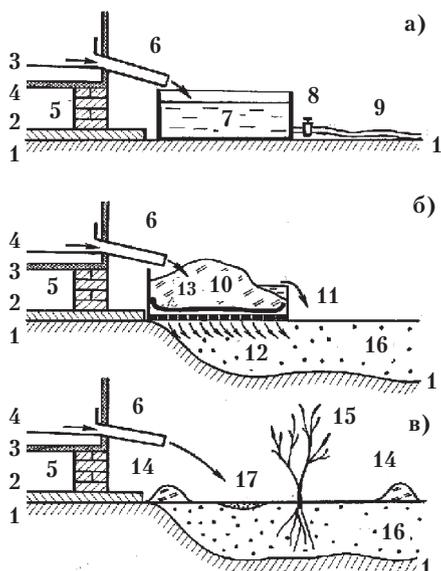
Схемы сбора и обработки стоков бани, сауны, душа на садовом и дачном участке: а – ассенизационная схема, б – схема компостирования, в – схема прямого сброса в фильтровальную траншею. 1 – грунт (почва), 2 – бетонная плита фундамента, 3 – ограждающие конструкции бани (полы, стены), 4 – поддон банный, 5 – цокольные столбики, 6 – сливной выпуск из поддона, 7 – бак-накопитель, 8 – кран шаровой, 9 – шланг поливочный, 10 – компостная куча (торф, старый перегной, песок, доломитовая мука), 11 – перелив очищенной (осветленной) сточной воды, 12 – фильтрующее дно, 13 – фильтрующая мембрана (войлок, лавсановая или капроновая ткань, нетканый синтетический материал, поролон и т. п.), 14 – обваловка места слива сточной воды, 15 – озеленяющий кустарник, 16 – фильтрующая траншея (песчано-гравийный фильтр), 17 – пятно слива (место поступления сточной воды в фильтровальную траншею).
